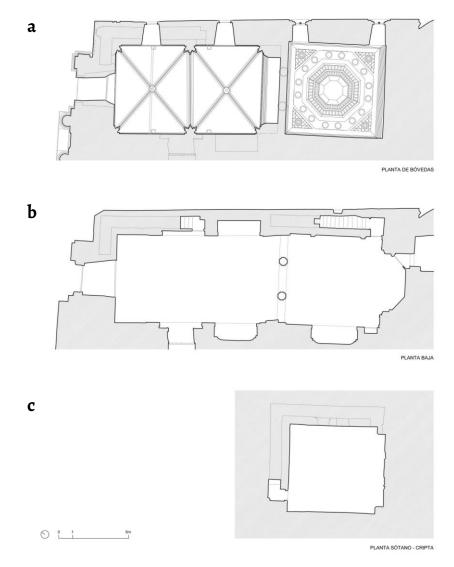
Plantas obtenidas a partir de delineado sobre la nube de puntos: a) planta de bóvedas; b) planta baja; c) planta sótano – cripta.
